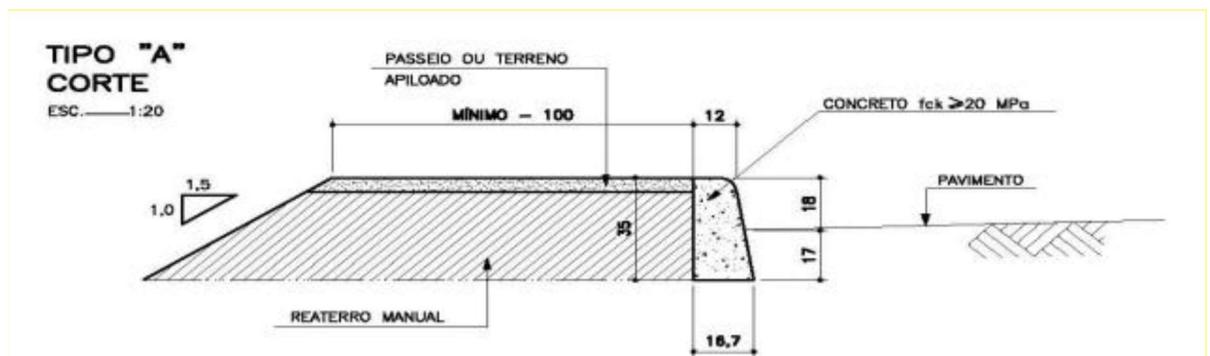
Meio Fio de Concreto Tipo A – padrão Sudacap
